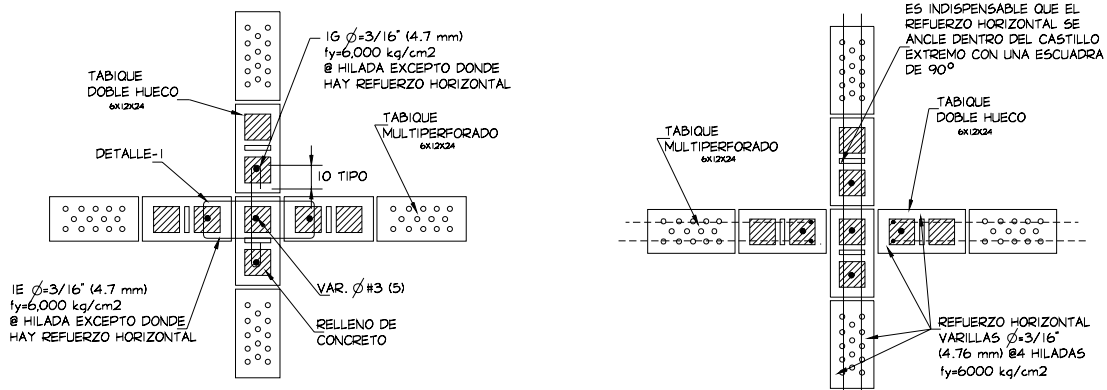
Detalle del castillo y de colocación del refuerzo horizontal (continuación)
